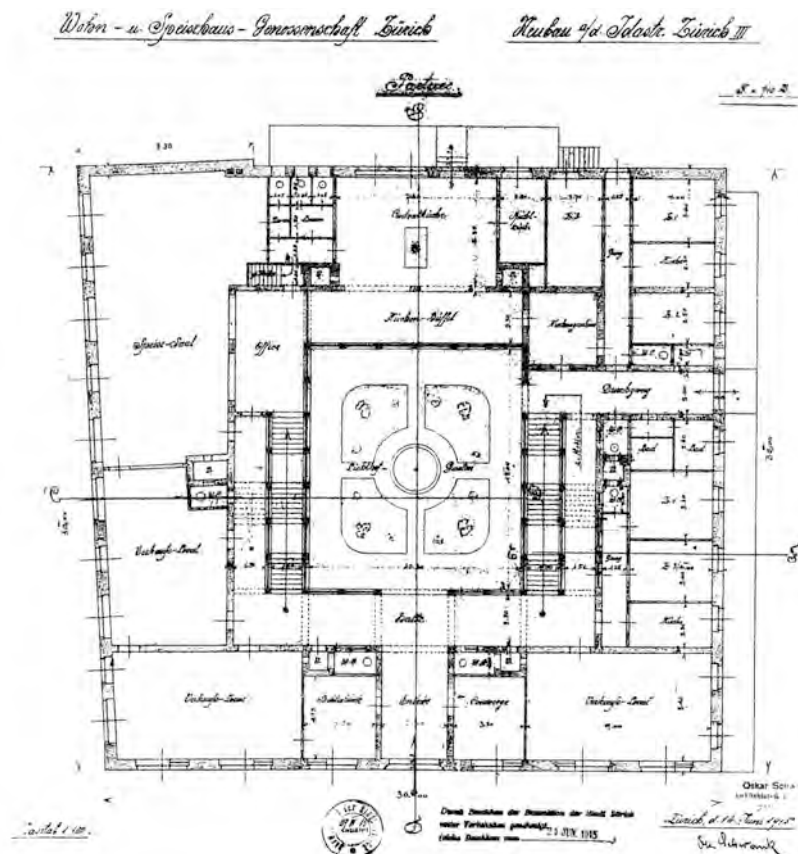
Grundriss des „Amerikanerhauses“ an der Idastr. 28, Zürich (1915).
